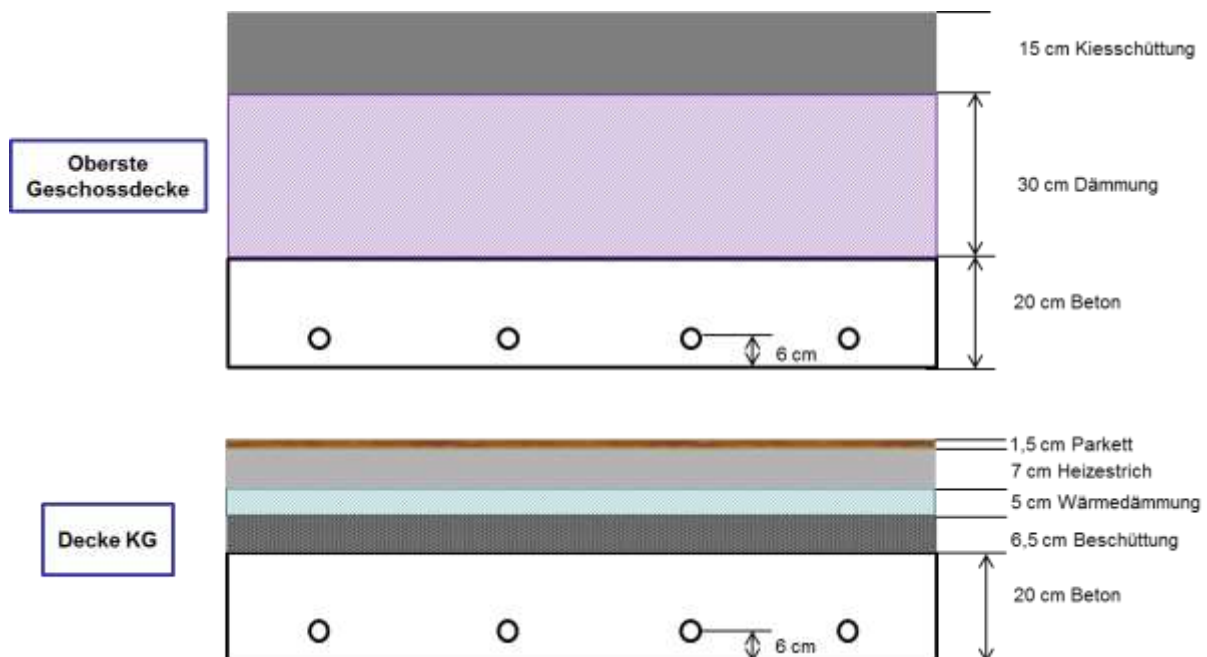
Aufbau der bauteilaktivierten Decke Kellergeschoss bzw. der obersten Geschossdecke inkl. Fußboden- bzw. Flachdachaufbau (Quelle: Planer, eigene Darstellung)
